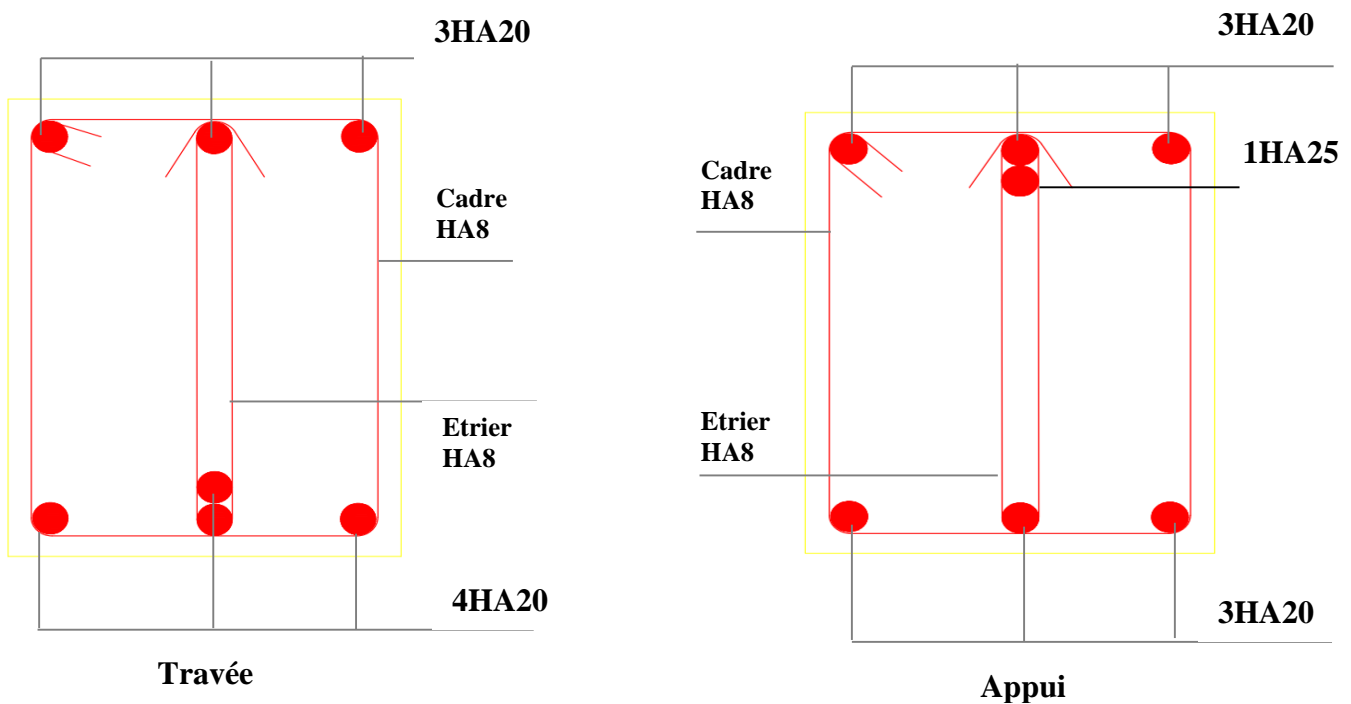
Schéma de ferrailage poutres principales Etages 1,2,3
